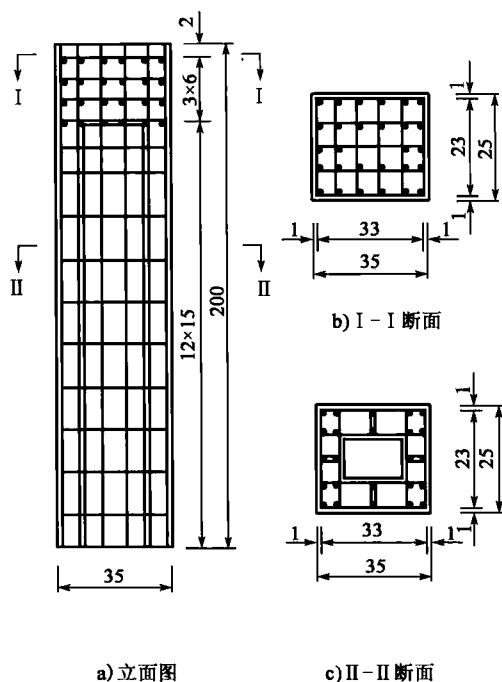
模型墩钢筋构造图(尺寸单位:cm)
